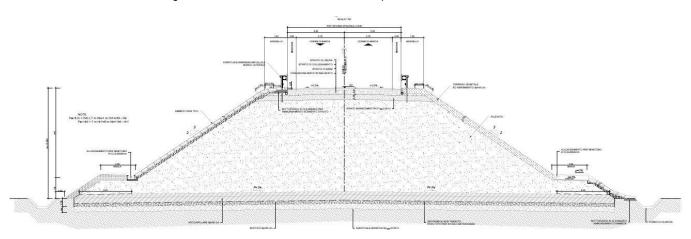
Dest. Particolare 6.5m - sezione tipo in rilevato Hril > 6.00 m
